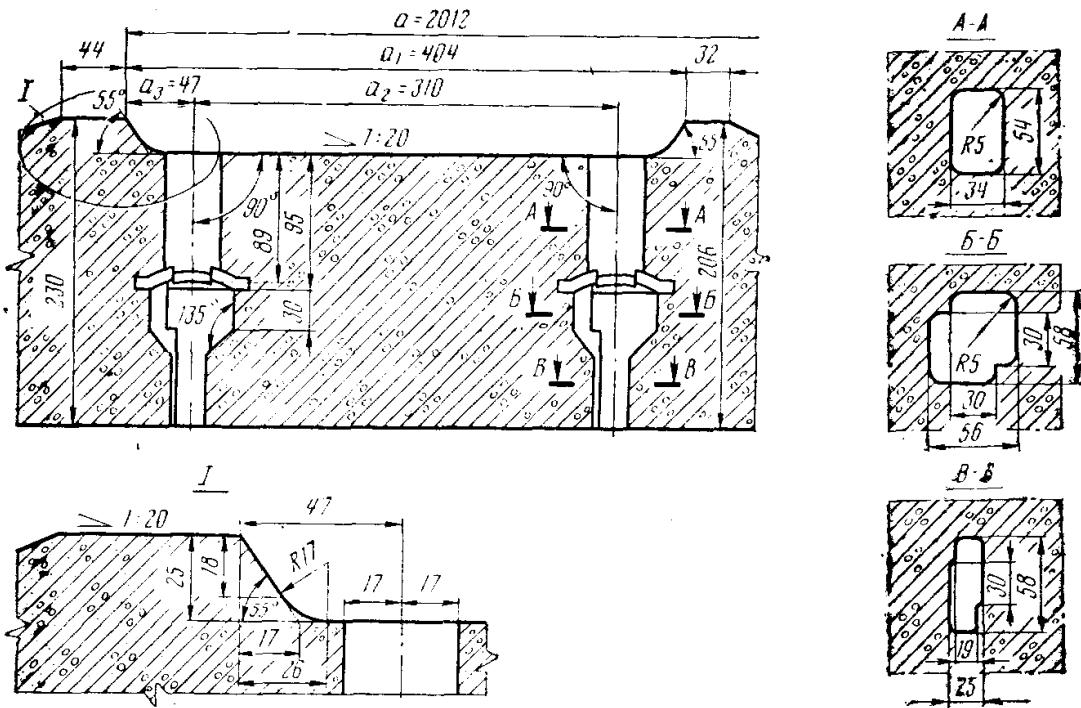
Железобетонные шпалы марок Ш1-1, Ш1-2, Ш2-1:
